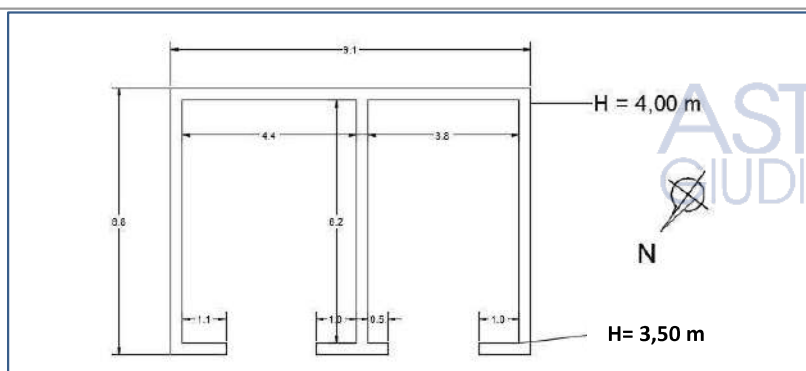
Pianta piano primo – Rilievo metico dello stato dei luoghi
